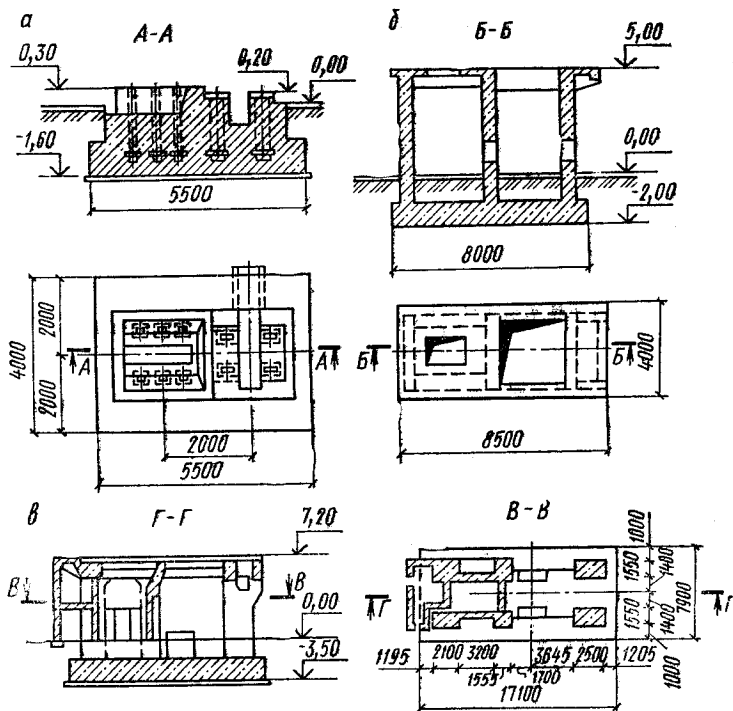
Фундаменты под машины, испытывающие динамические нагрузки
